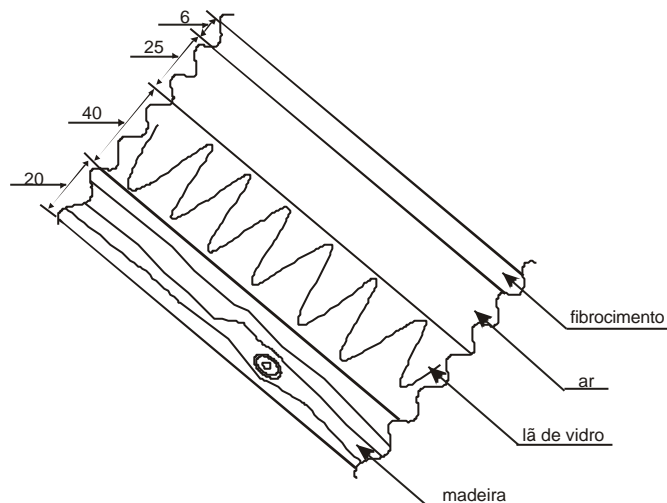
Detalhes da cobertura, medidas em mm.
